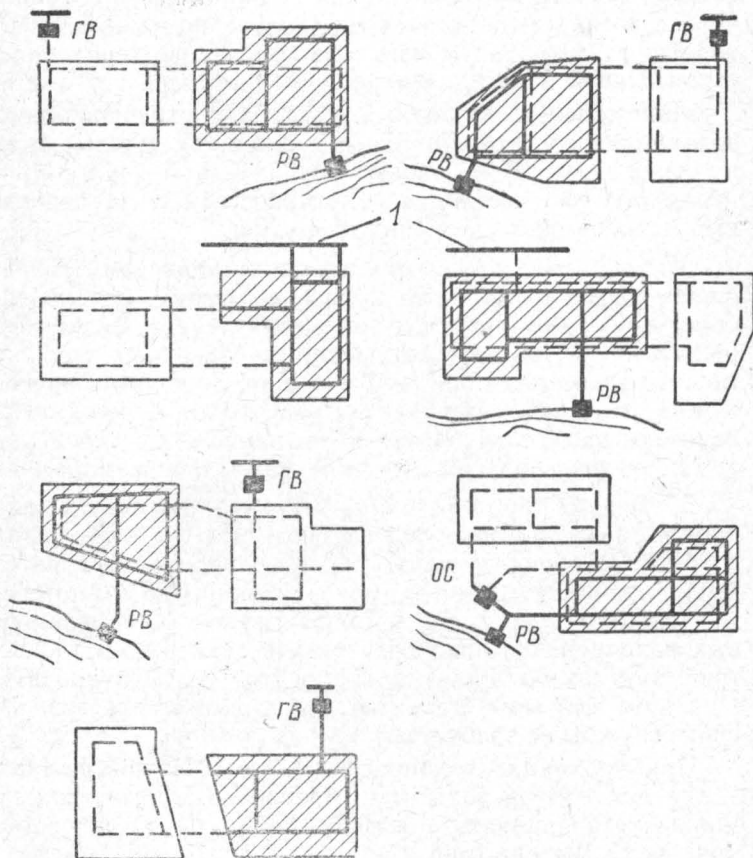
Различные схемы противопожарного водоснабжения строительных площадок
